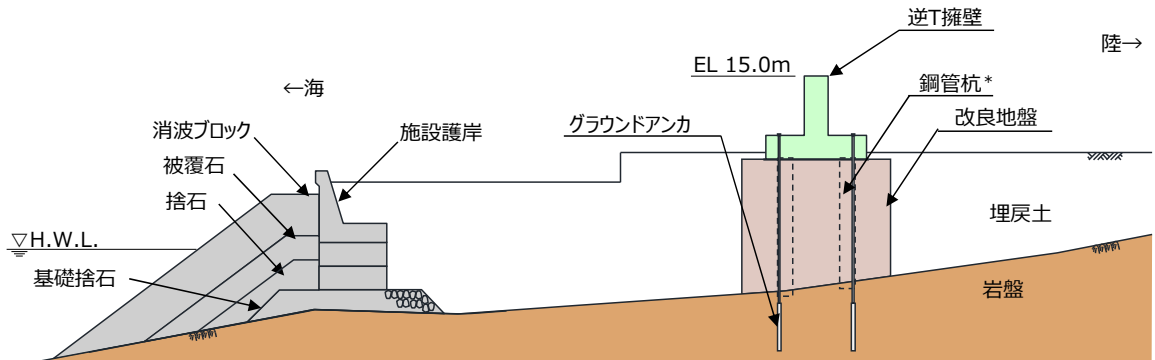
防波壁（逆 T 擁壁）の縦断面図
